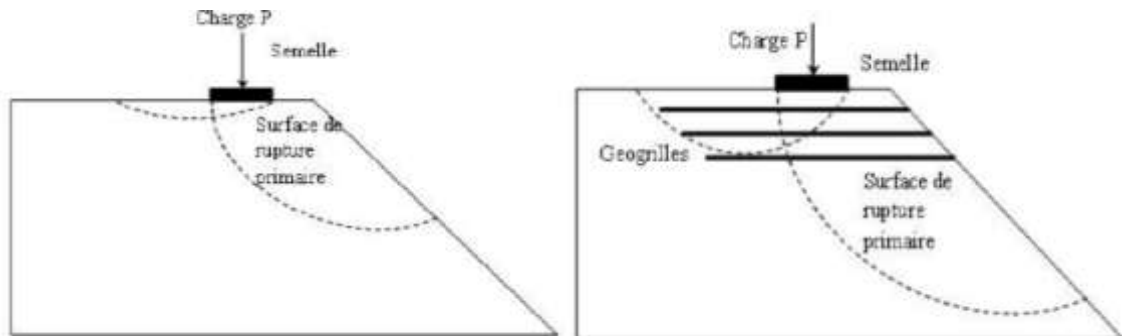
Mécanisme de rupture d'une semelle filante reposant sur un sol en pente.
